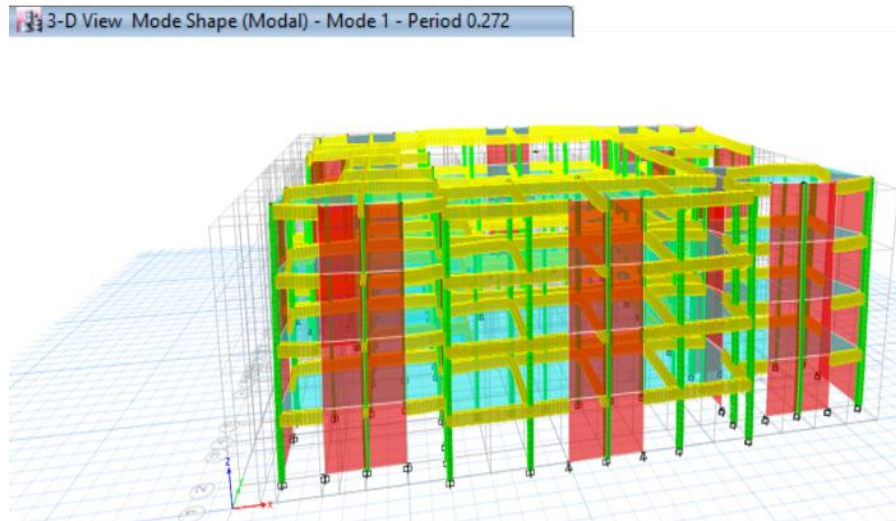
Modelación de la alternativa de reforzamiento con placas en la edificación del Pabellón D de la Universidad Privada Antenor Orrego
